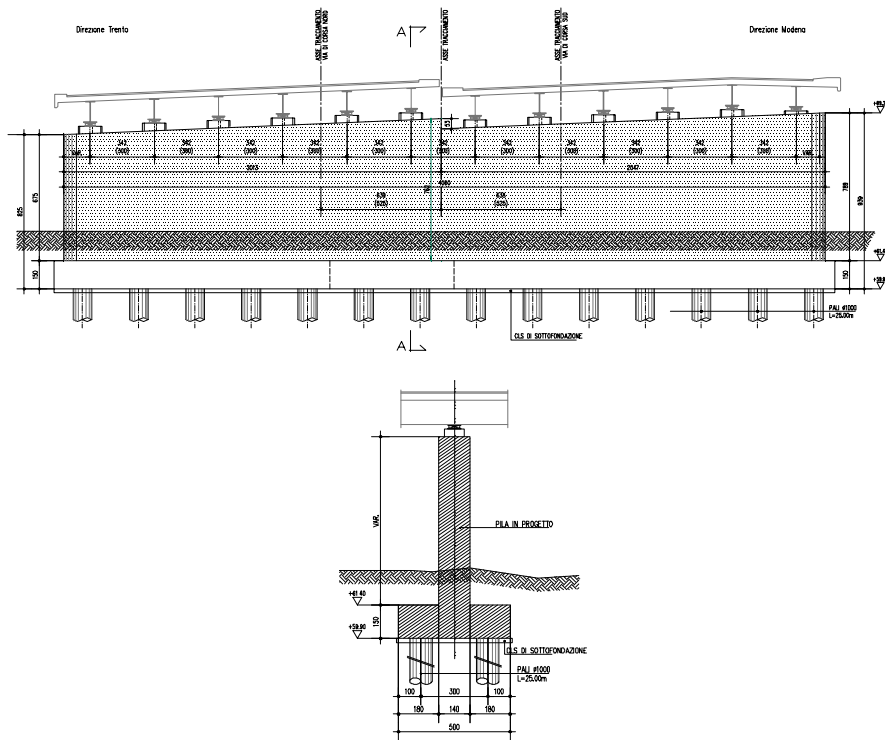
Pila - Sezione in retto impalcato e sezione trasversale
